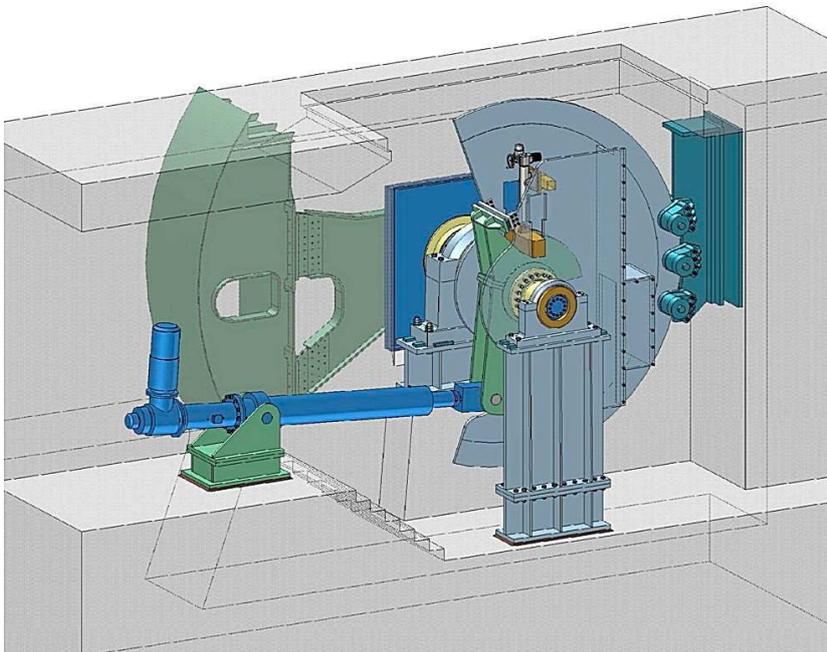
Drucksegmenttor mit EHZ-Antrieb
